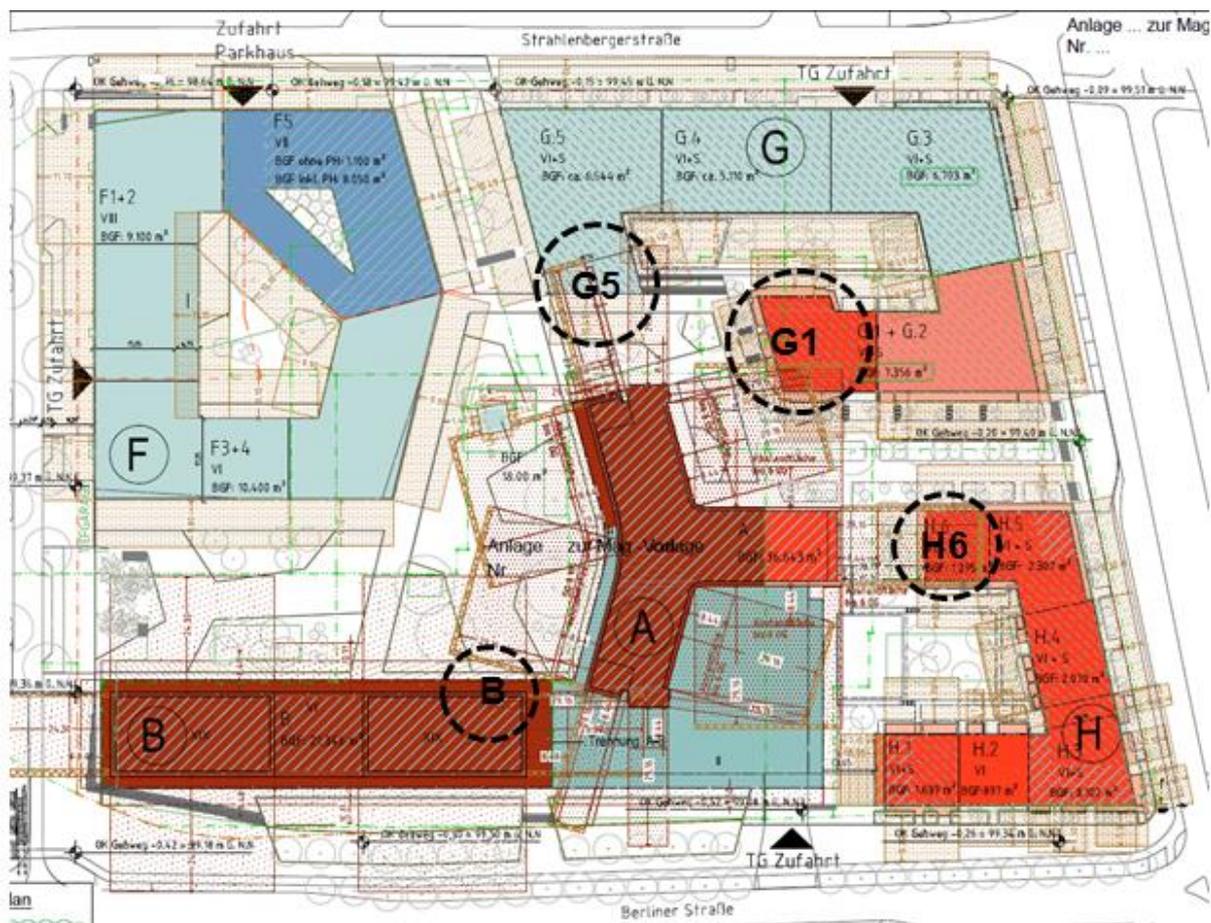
Lage der untersuchten Räume (Plangrundlage: Eike Becker Architekten, 2019)
